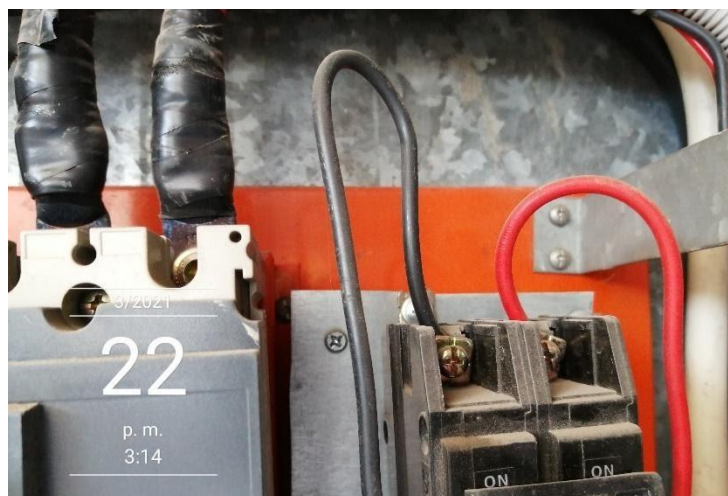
Tablero eléctrico TD2 – Zona de húmedos
